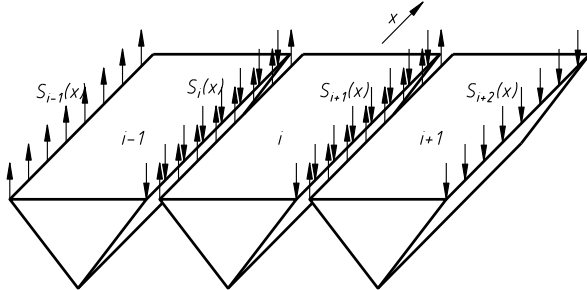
Схема к расчету перекрытия с учетом пространственной работы
